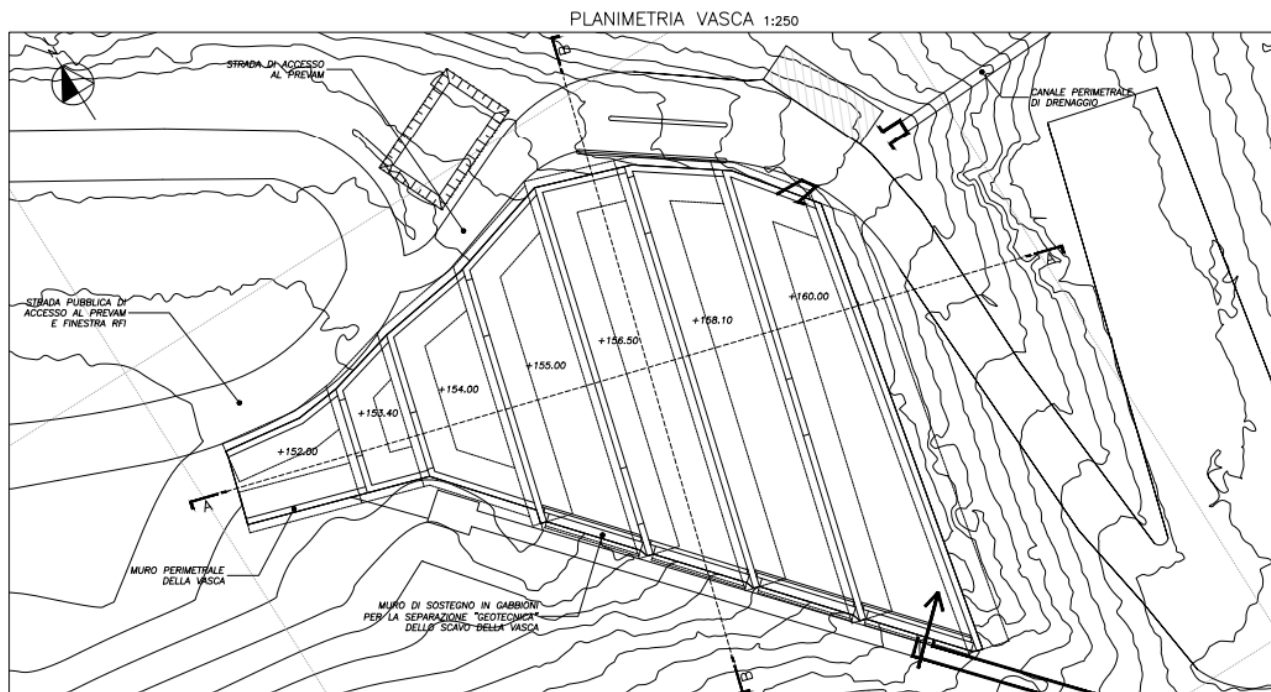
PLANIMETRIA VASCA DI SEDIMENTAZIONE
